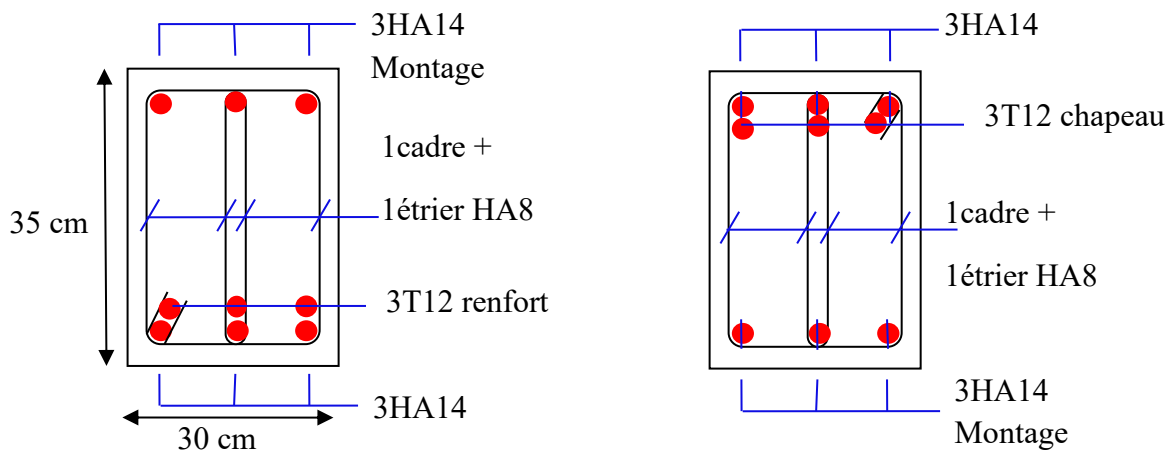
Ferrailage de poutres principales (30x35) en travée et en appui respectivement
